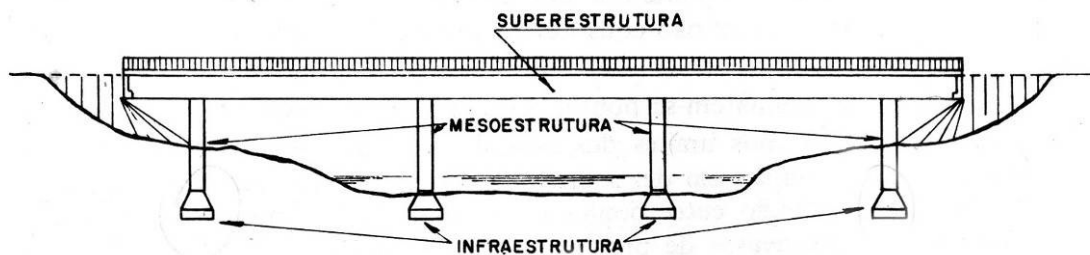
Grupos de elementos que constituem a estrutura de uma ponte (PFEIL, 1990).
